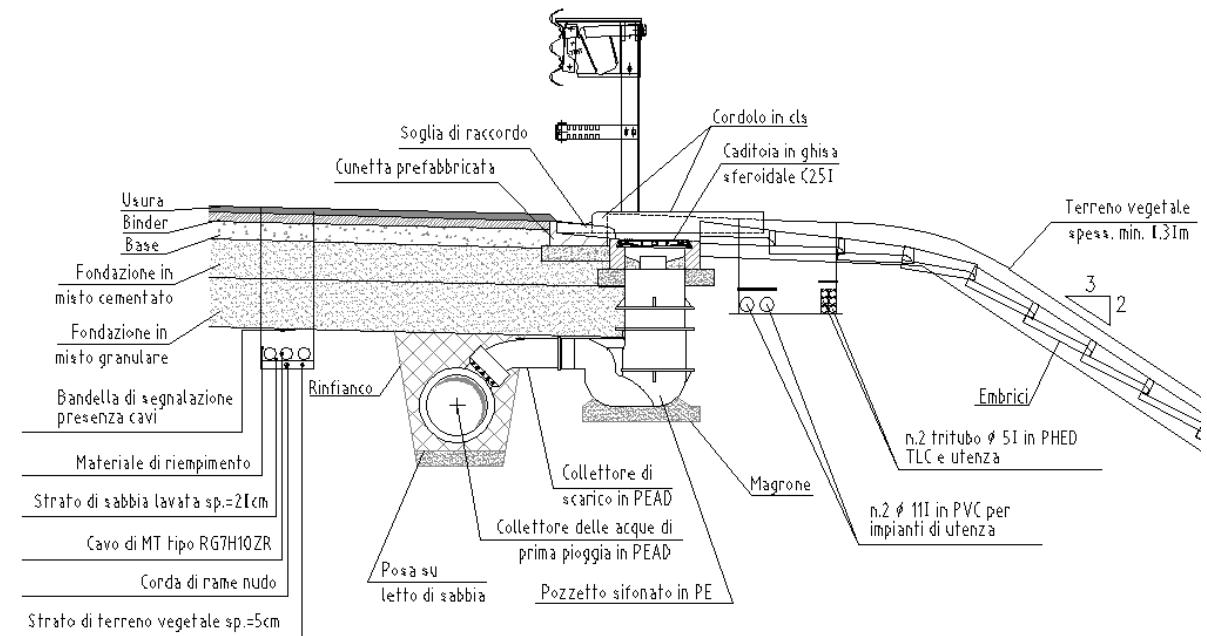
Sistema di drenaggio in rilevato in corrispondenza del pozzetto
